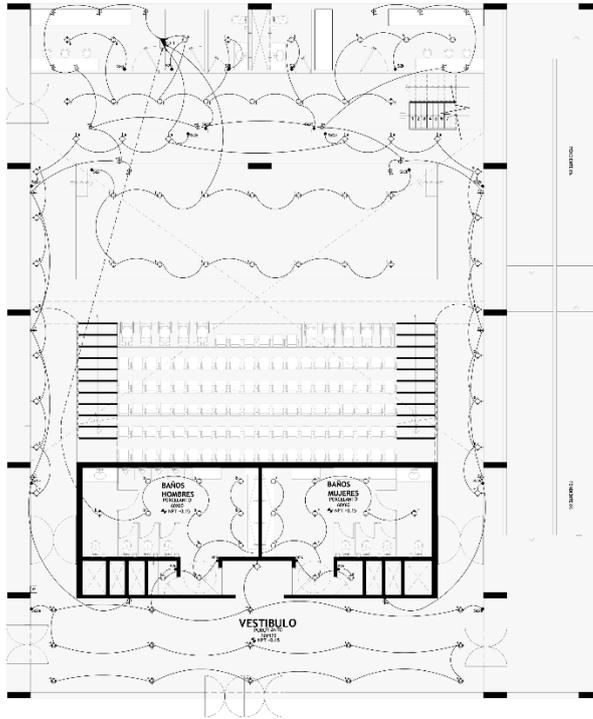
plano de 1er piso auditorio de instalación eléctrica; Fuente: Propia
